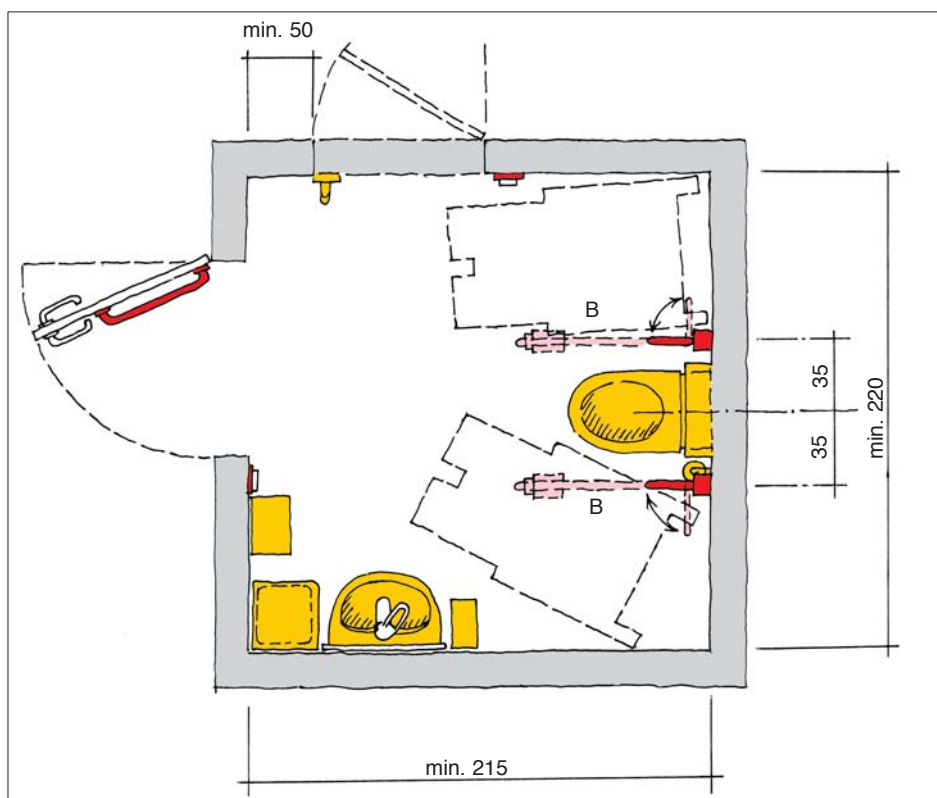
Grundrissvariante mit beidseitig anfahrbaren WC-Sitz
